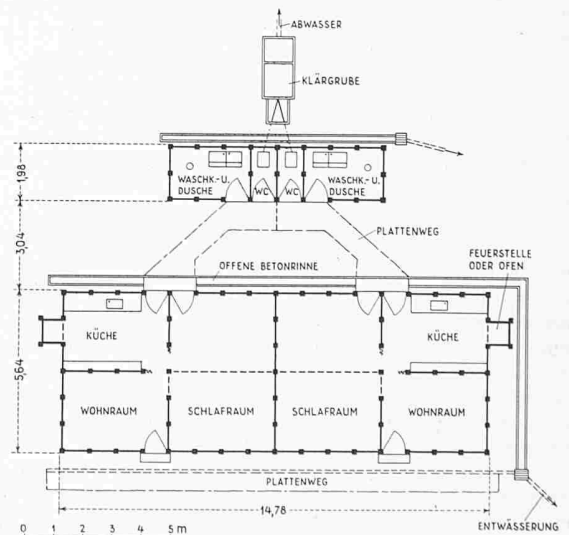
Grundriss einer Zweifamilieneinheit 1:250
